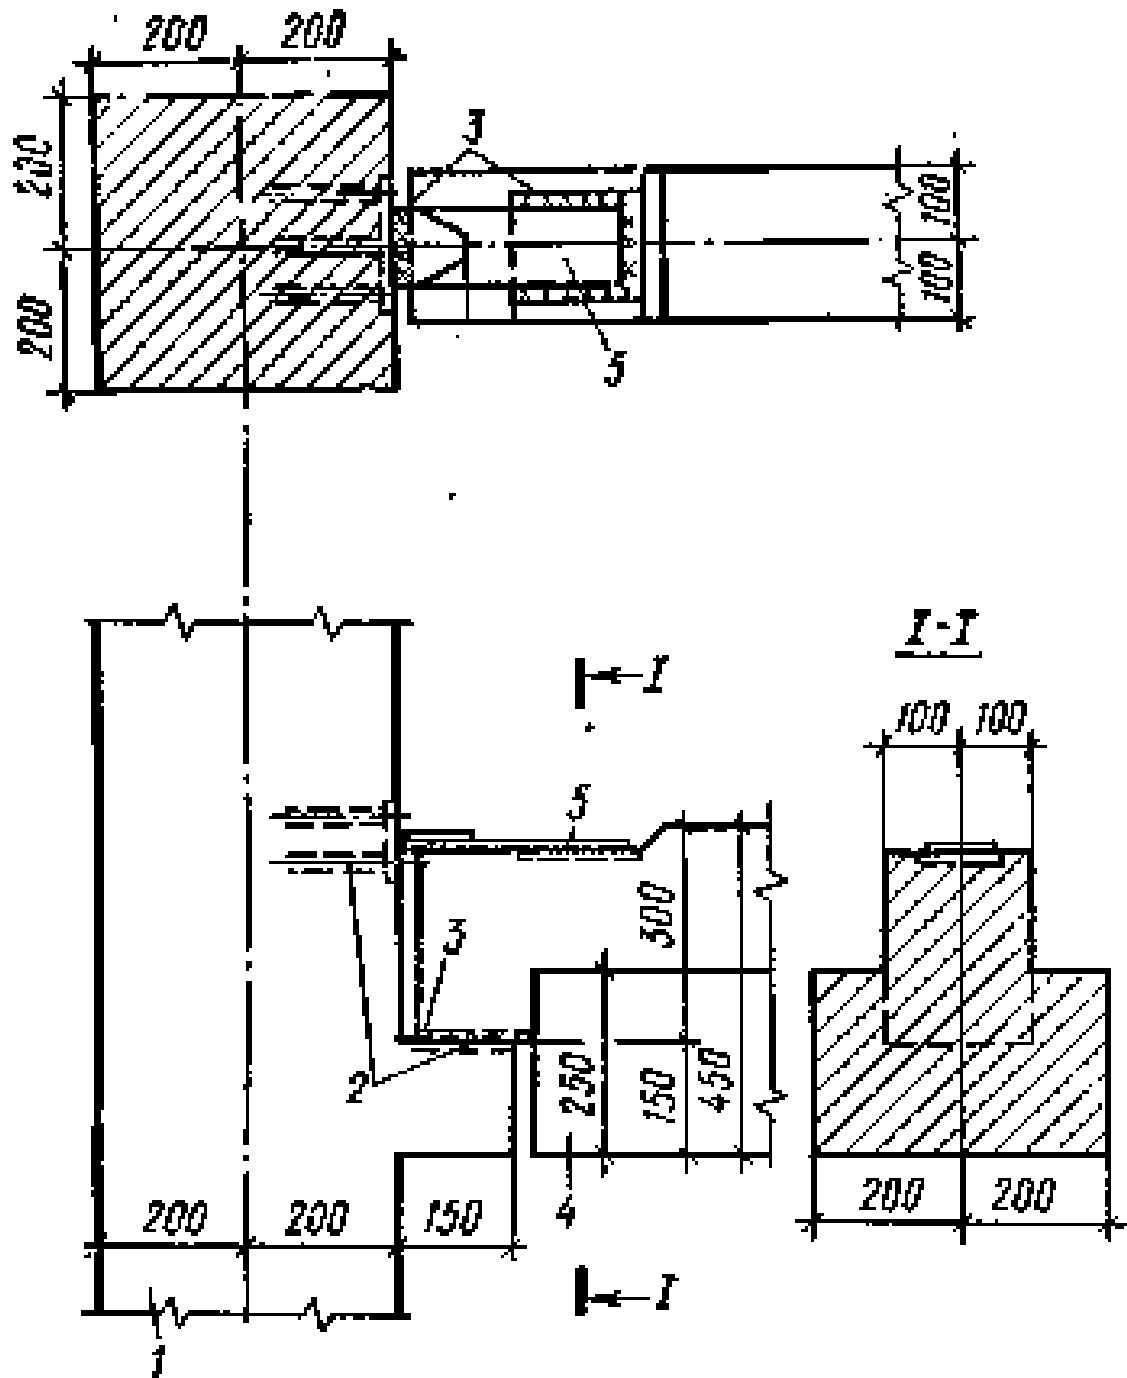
Узел сопряжения поперечного ригеля с колонной унифицированного каркаса:
